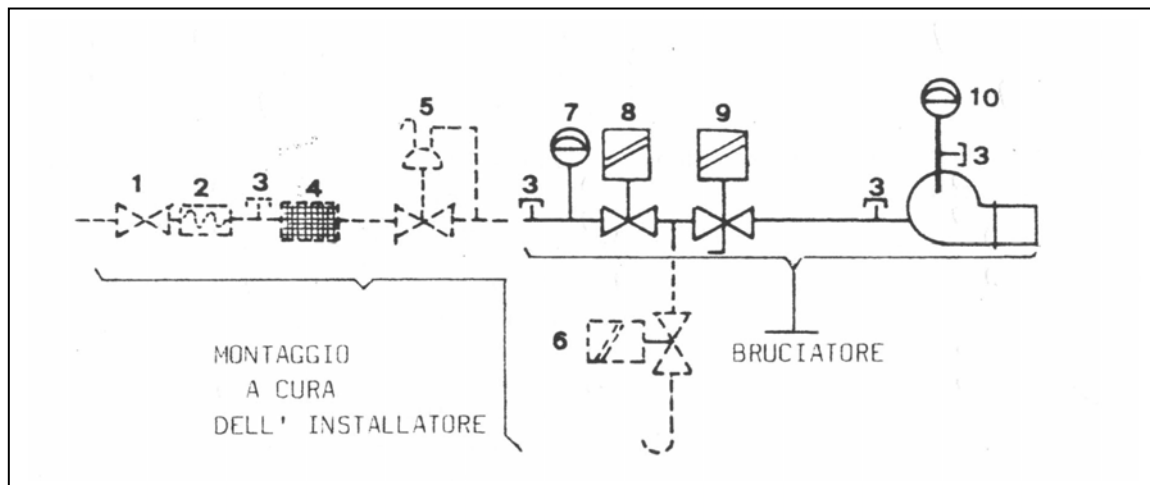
montaggio a cura dell'installatore = montare realizata de instalator
